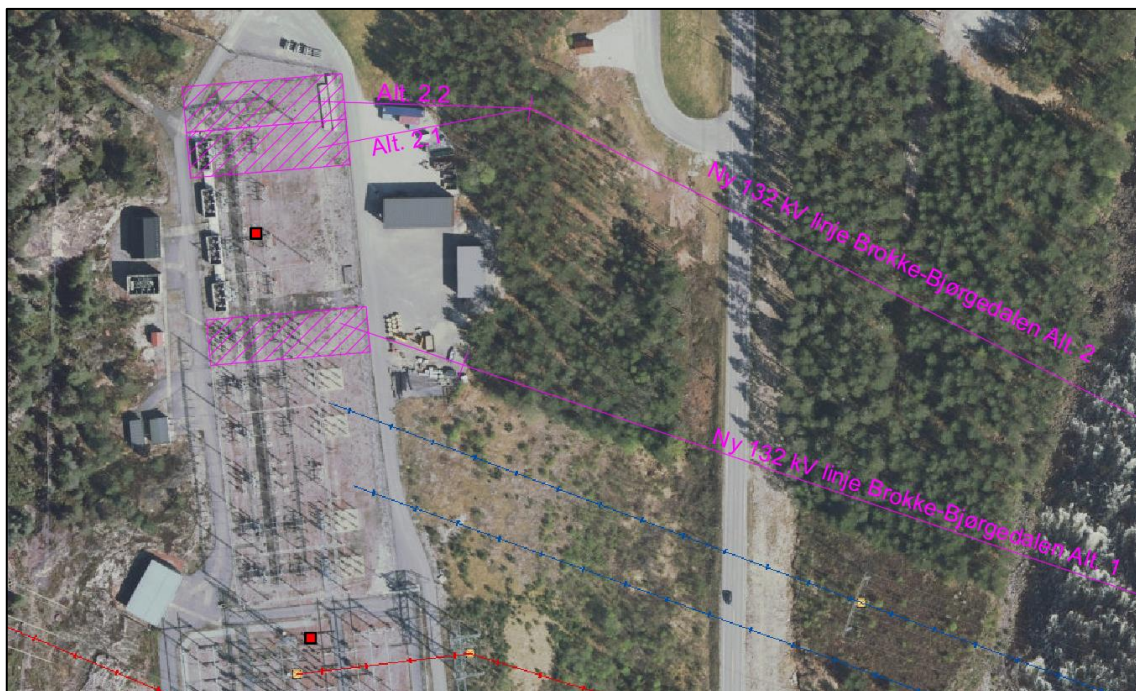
Situasjonsplan Bjørgedalen koblingsstasjon.
